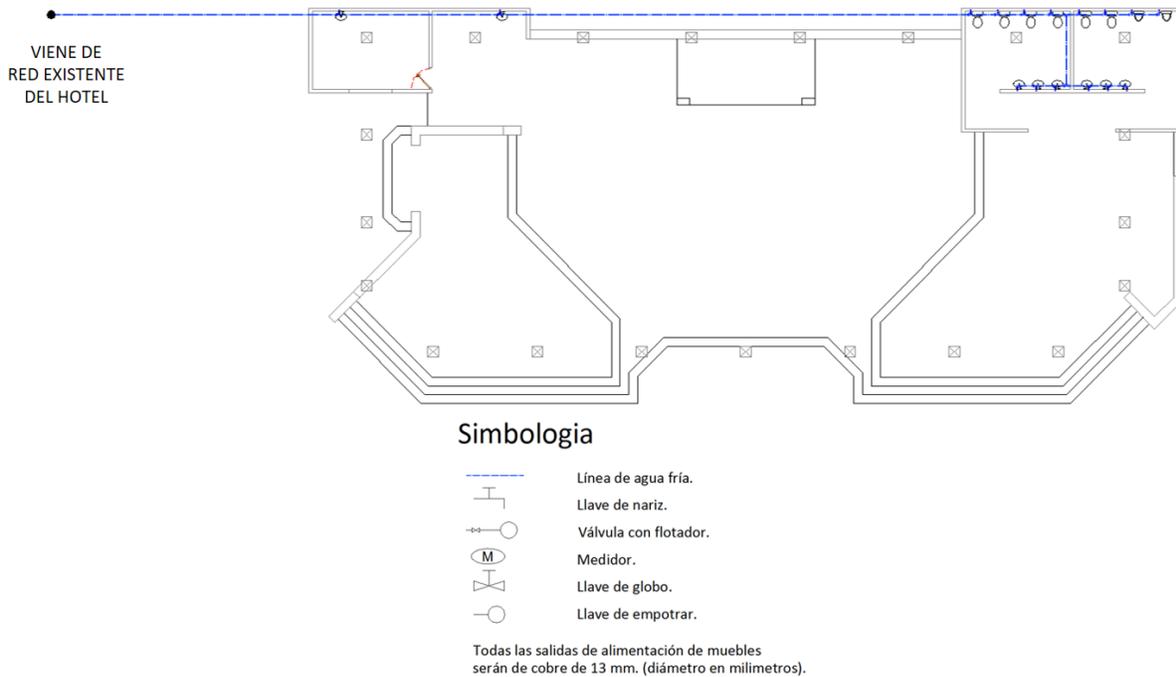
Detalle de planta de instalación hidráulica del proyecto. Fuente: Promovente.
